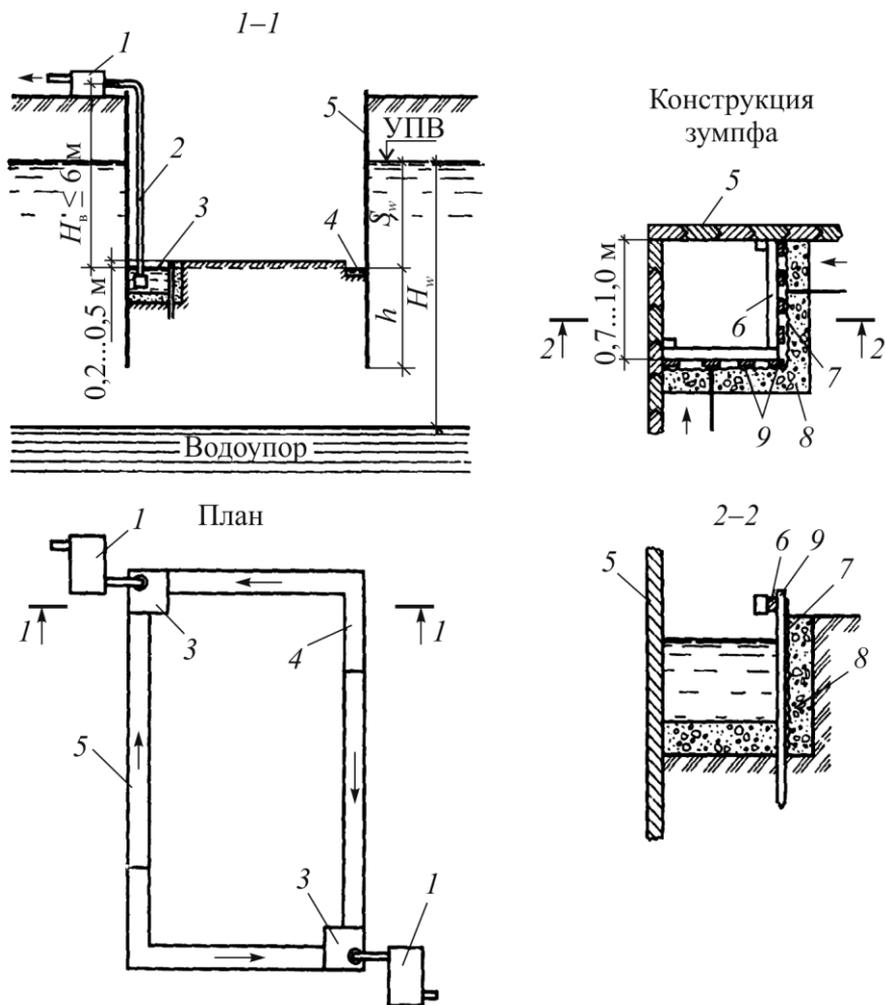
Схема открытого водоотлива: 1 – насос; 2 – всасывающий шланг; 3 – зумпф; 4 – канавки; 5 – шпунты; 6 – обвязка; 7 – металлическая сетка; 8 – фильтрующая отсыпка из песка и гравия слоем 15–20 см; 9 – доски, забитые вертикально
